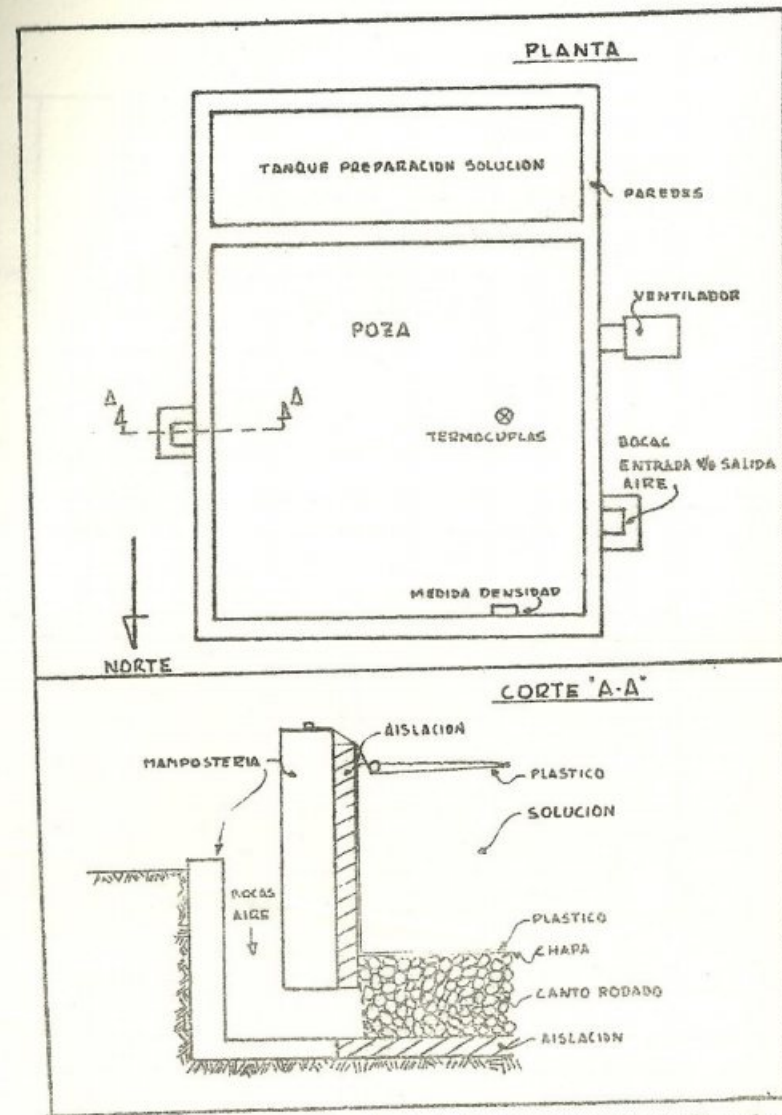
Muestra un corte y la planta de la poza construida con fines de experimentación. La longitud de un lado de la poza es de 4 metros.
